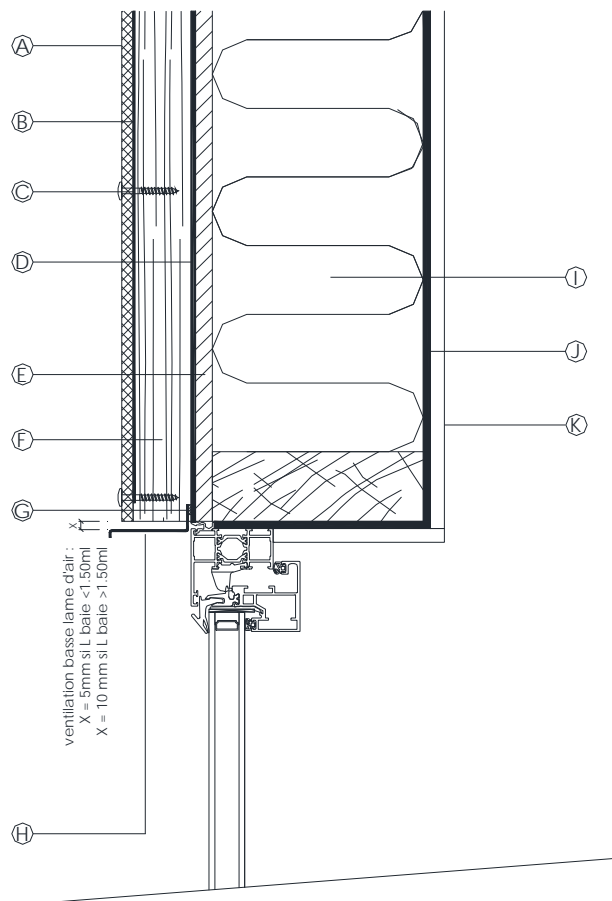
Pose sur COB – Coupe sur linteau de baie
